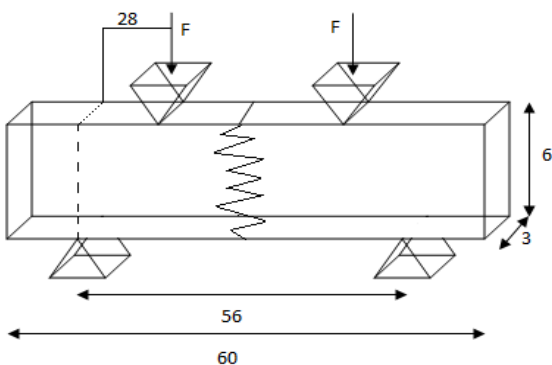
Caractéristiques géométriques de la poutre test 2(avec entures sur face).
